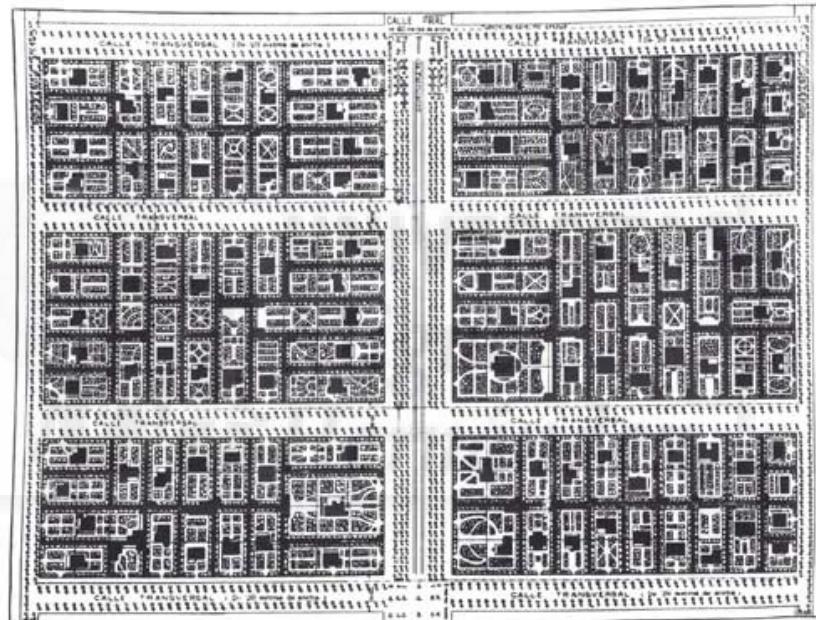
Plano planta de manzanas y perfil de calle de la ciudad lineal de Arturo Soria. Fuente: (Navascues Palacio, 1969, 1973). Elaboración propia.
